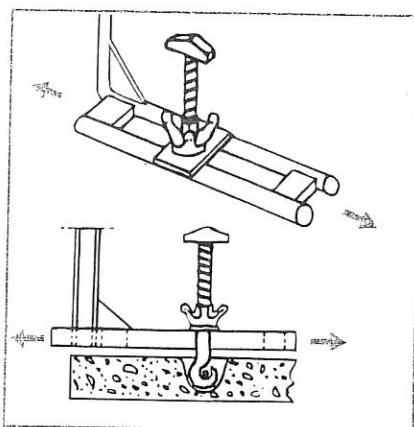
Dispositif de fixation par ancrage dans la dalle (ne doit pas être fabriqué sur chantier, mais par un fabricant spécialisé).
